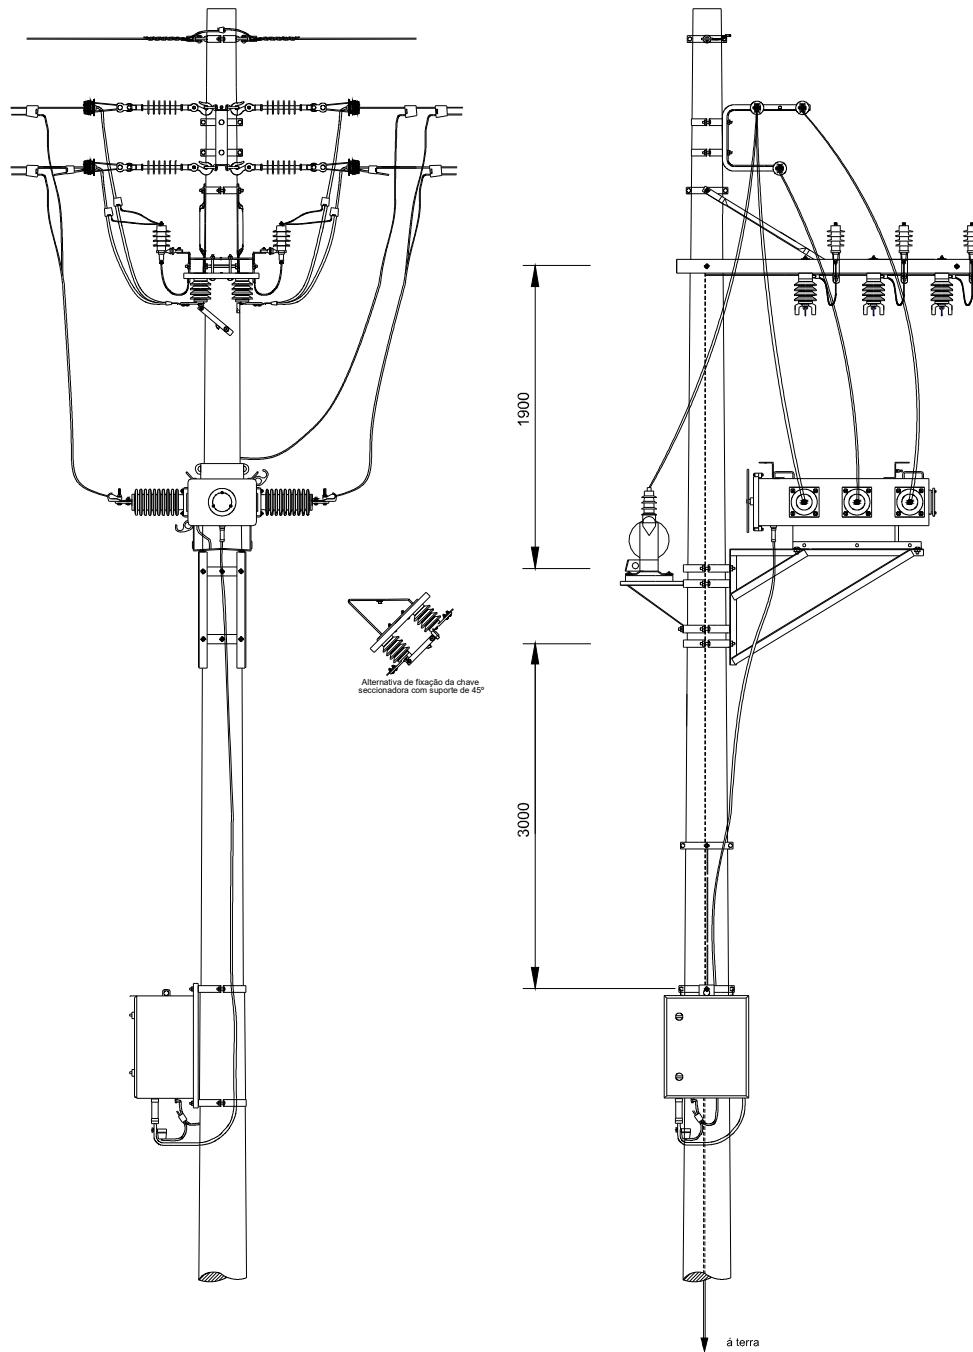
Instalação de equipamento – Chave seccionadora tripolar
